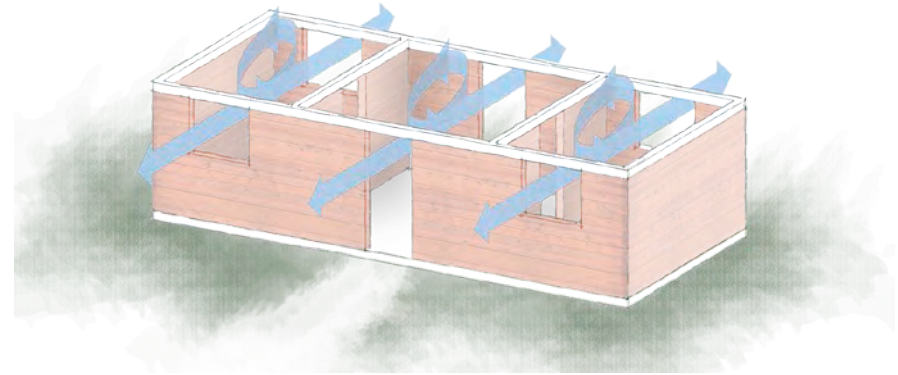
Croquis esquemático de funcionamiento de ventilación cruzada en construcción de tablas de madera.
